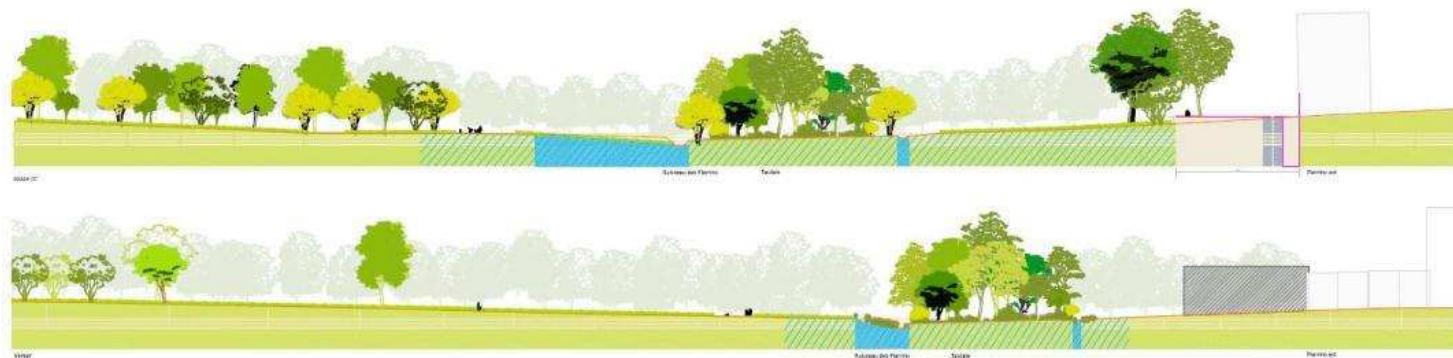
PROFILS EN TRAVERS DE BOUDEBOIS AU NIVEAU DU RUISSEAU DES PIERRINS (DEVILLERS, 2015)
